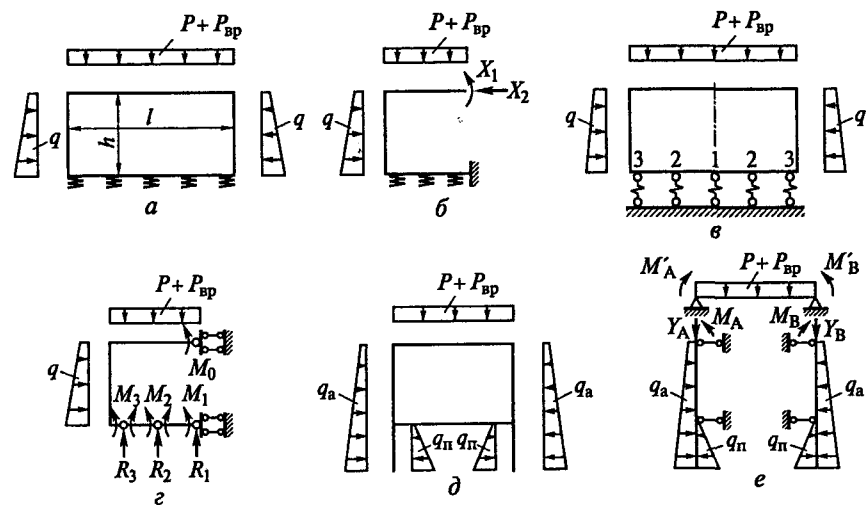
Схемы расчета монолитных обделок тоннелей, сооружаемых котлованным (а—г) и траншейным (д, е) способами
